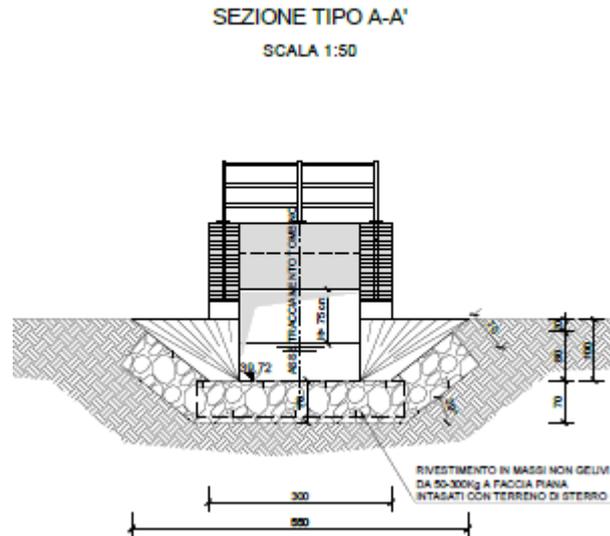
I – PARTICOLARE ESECUTIVO SEZIONE ATTRAVERSAMENTO TM14 (S01ID00IDRDI19).
